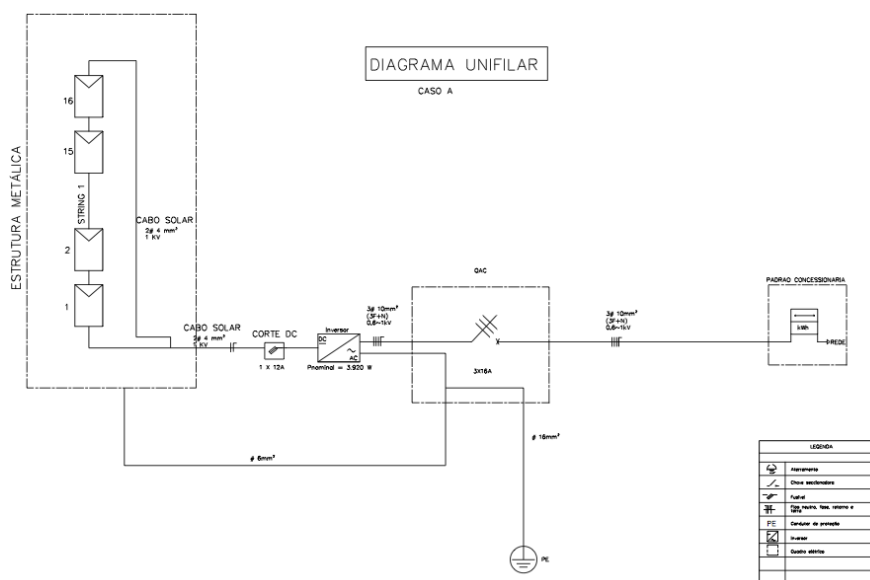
Diagrama Unifilar da Planta de Geração Caso A (Anexo B1)
